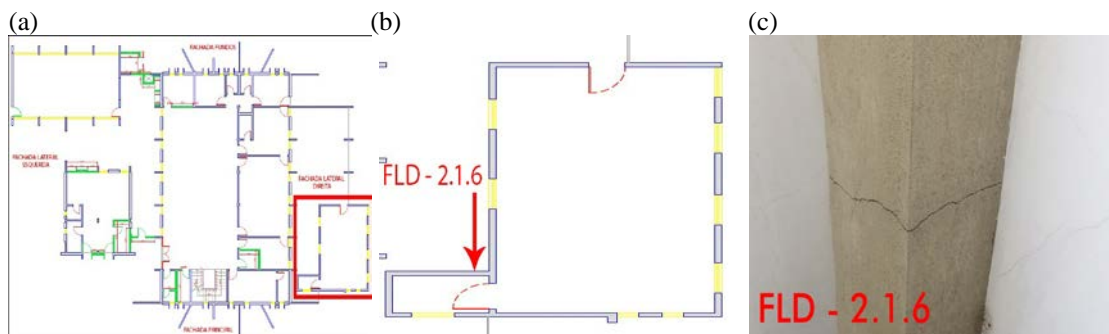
Trinca horizontal: (a) planta baixa do pavimento térreo, (b) planta baixa ampliada indicando onde a manifestação de patologia se encontra, (c) foto da manifestação de patologia
